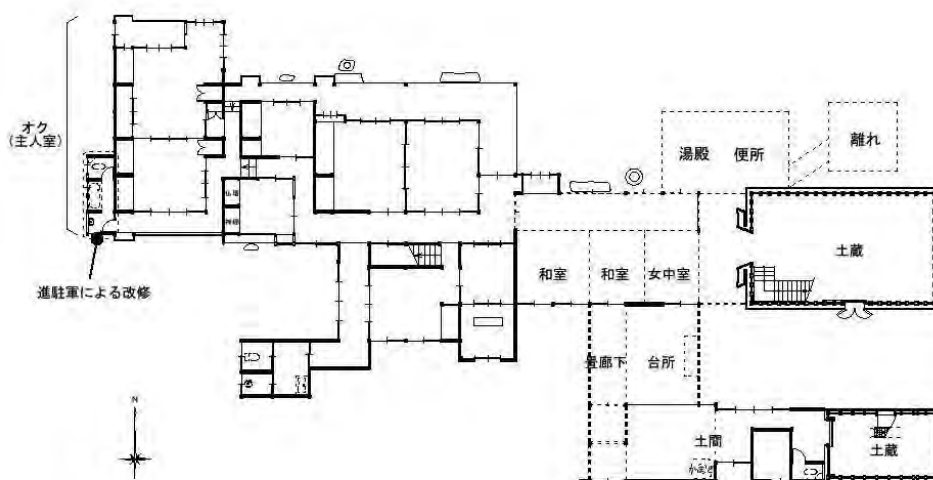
昭和 57 年増築工事前の主屋平面図(加賀田亮一氏ヒアリングによる)
